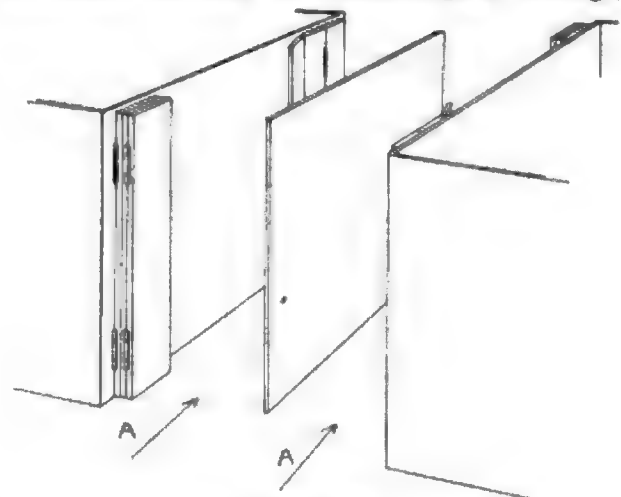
GEÖFFNETE SCHLEUSSENTÜR.
